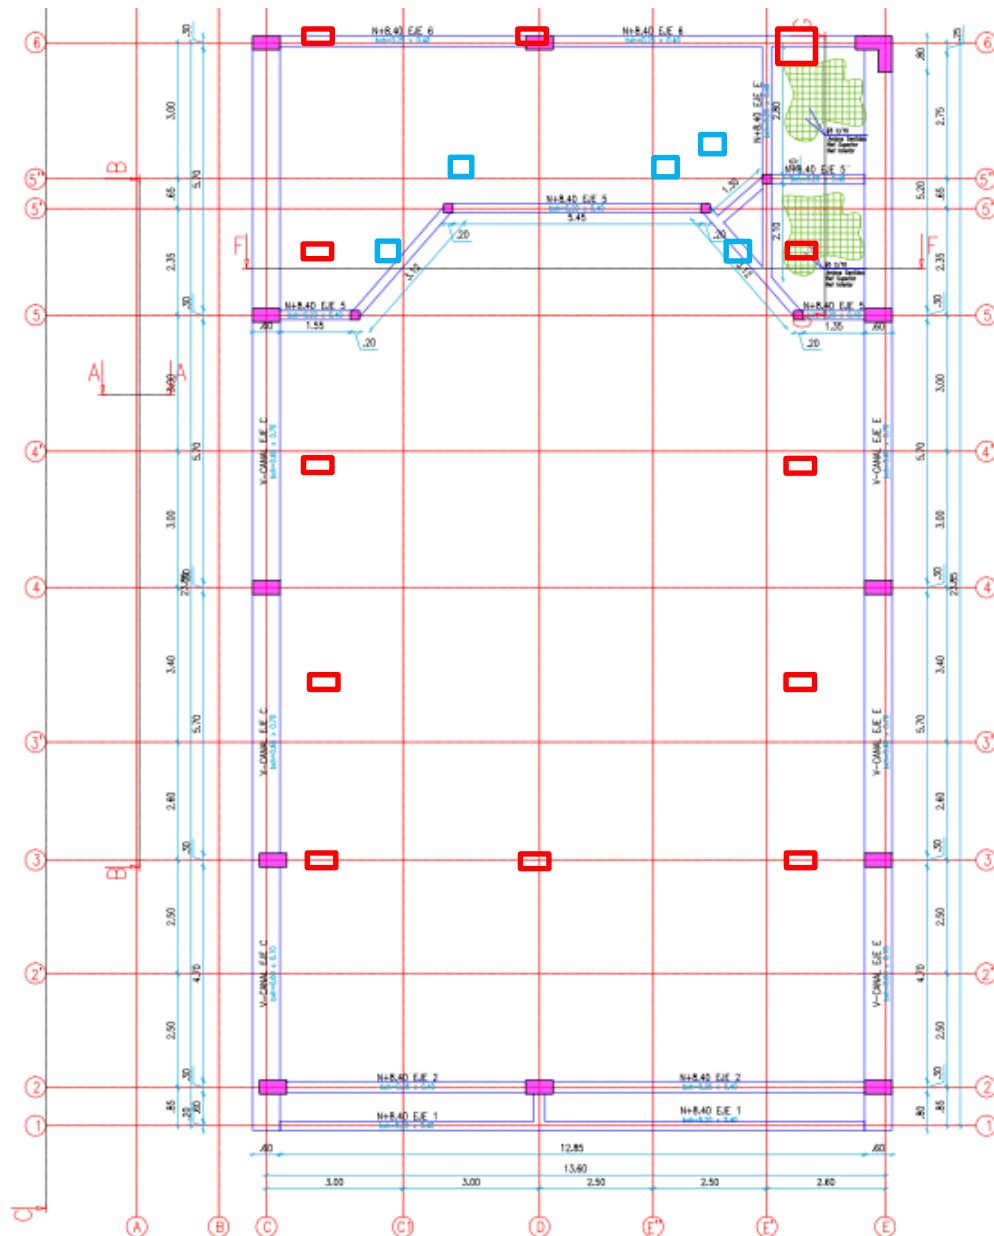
Localización de columnas (Planta segundo piso) Fuente: Planos del proyecto
